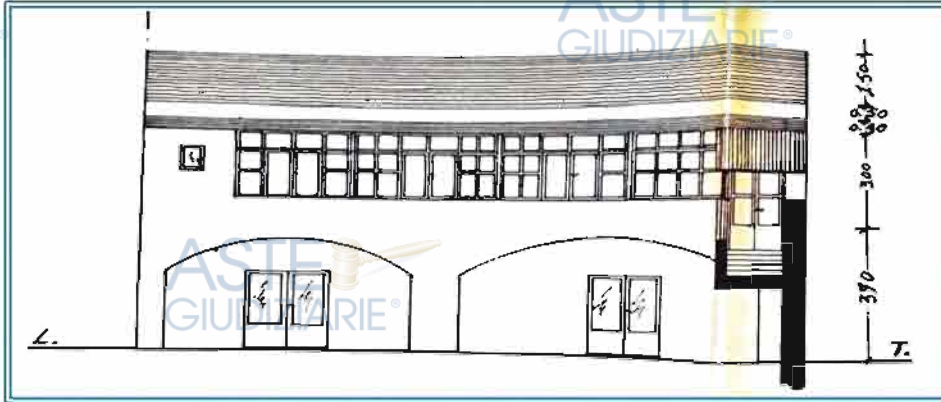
Prospetto (post operam) – estratto dal fascicolo pratica di costruzione edile n. 5951 del 17.03.1988
